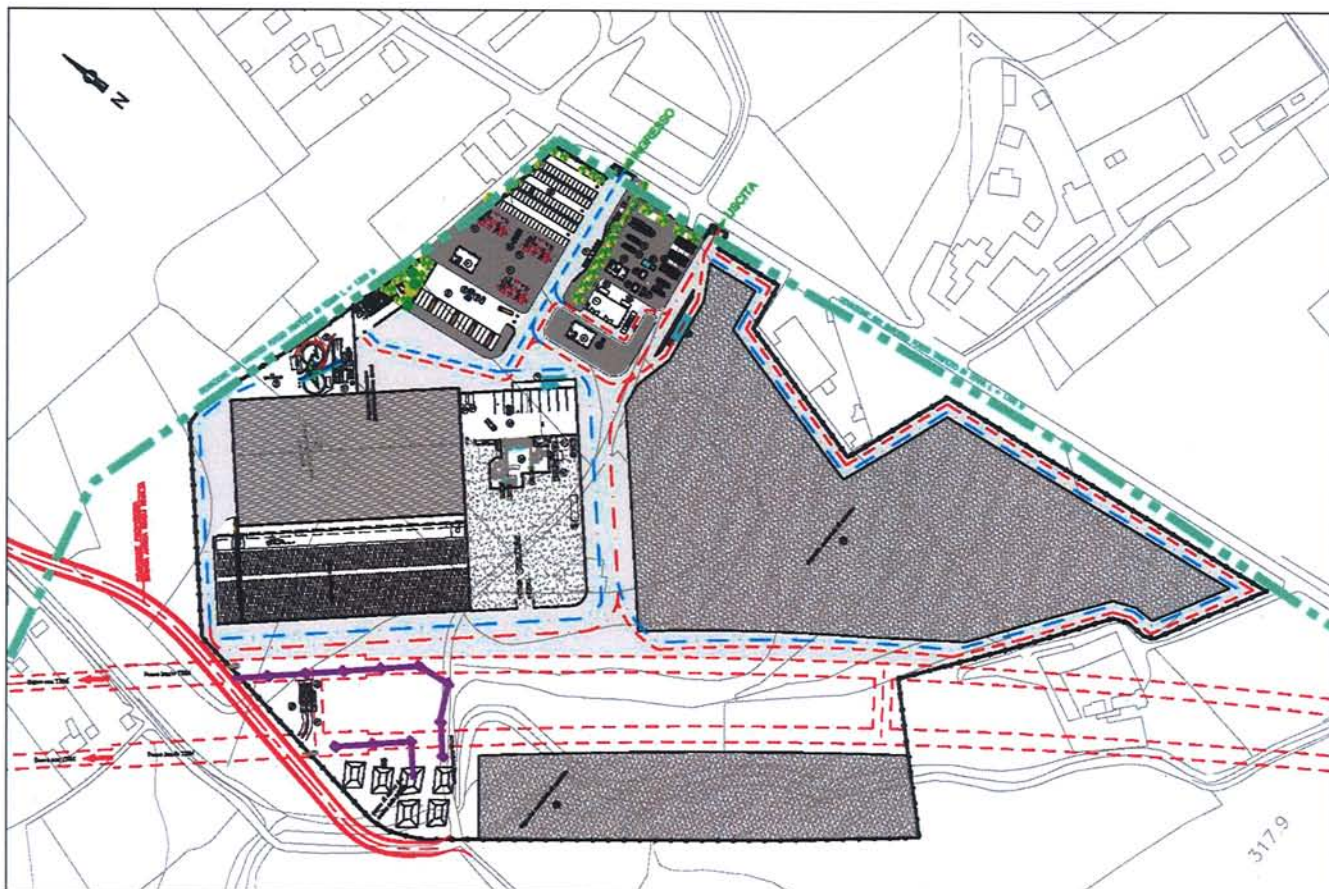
Stralcio planimetrico del cantiere di Rivoli – Progetto Preliminare
